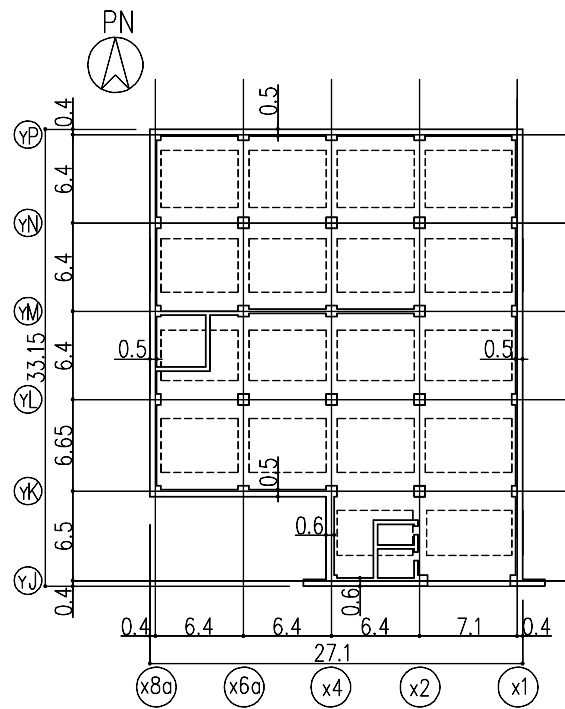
地下2階平面図 (G.L. -8.7) (単位 : m)
